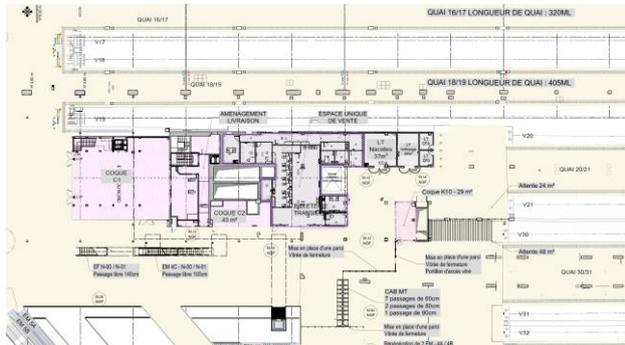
Illustration de la dalle 1 en situation future (Source : Gares & Connexions)
